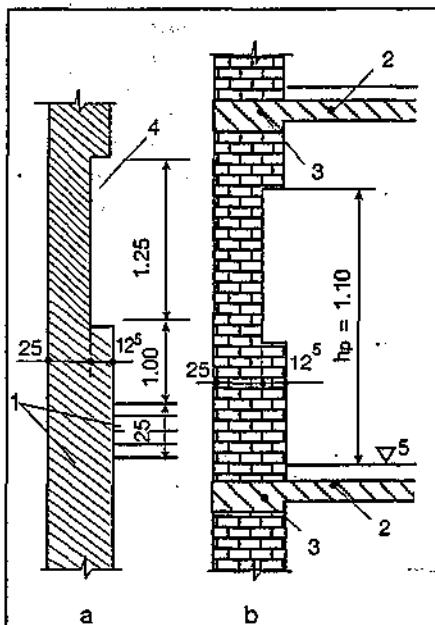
Nișe pentru instalații: a - vedere în plan; b - secțiune verticală 1 - perete; 2 - placa planșeului; 3 - buiandrug; 4 - nișă 1,25x1,00x125 la $h_p = 110$; 5 - nivel pardoseală.
